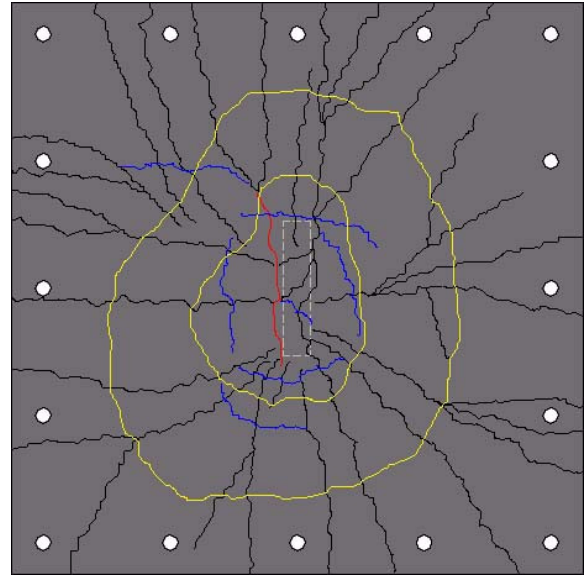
Mapa de fissuração das lajes do grupo 2
